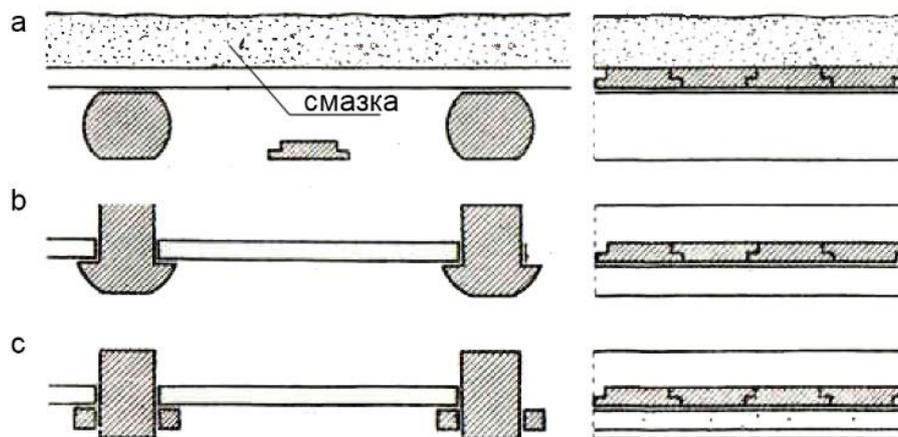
Черные полы в перекрытиях по деревянным балкам: а – простильный черный пол с опиранием по верху балок; б – наборный черный пол с опиранием на черепа бревенчатых балок; с – наборный черный пол с опиранием на черепные бруски брусчатых балок [33]
